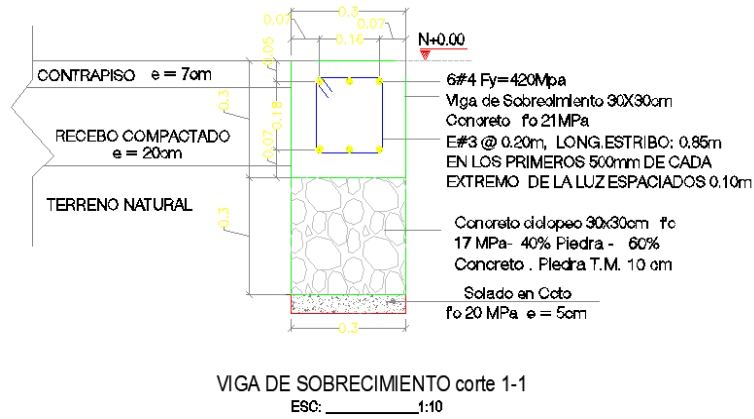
Estructura de sobrecimiento AUTOCAD.
